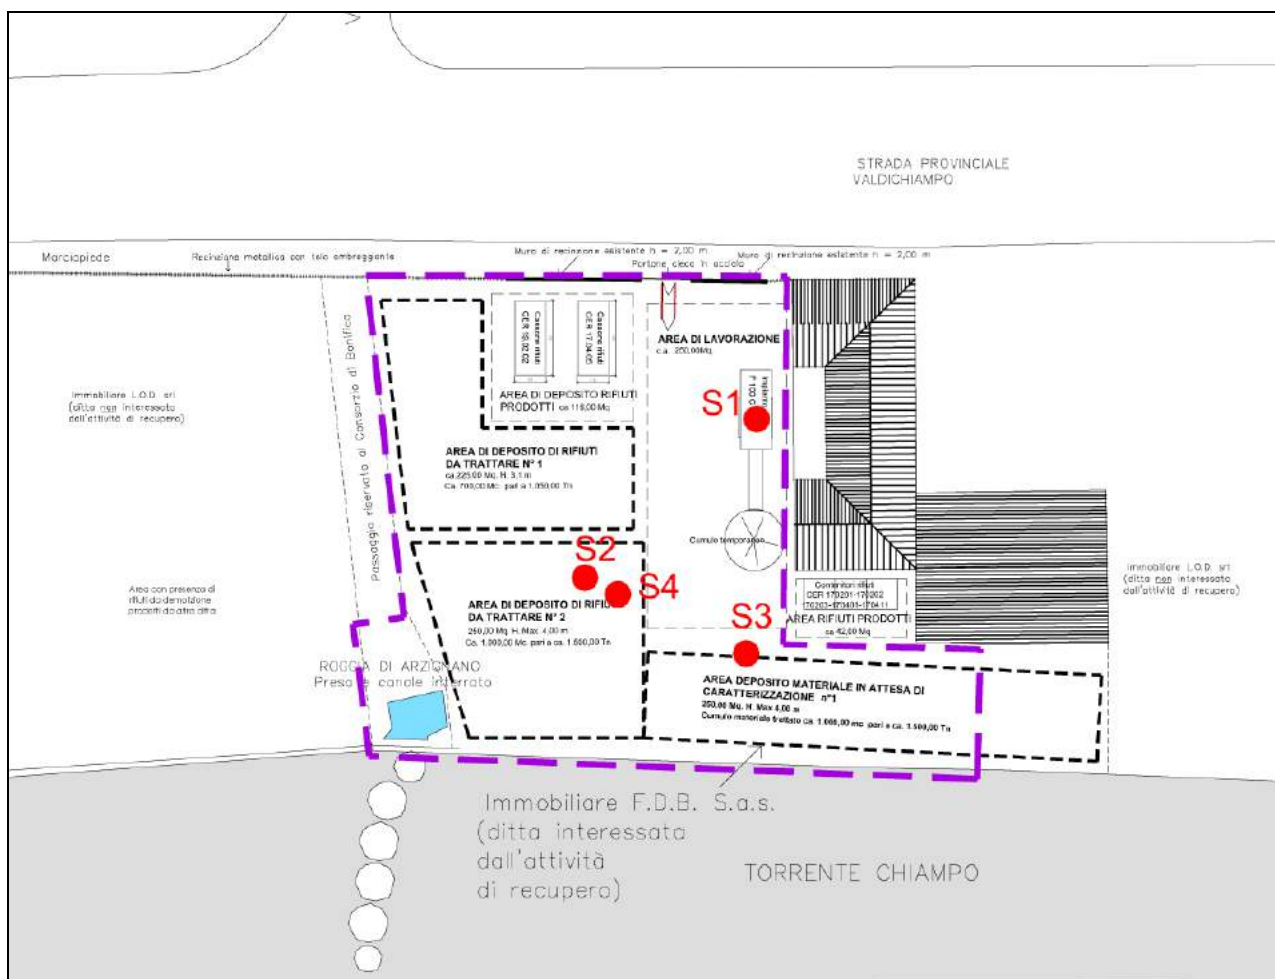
Planimetria di cantiere allegata al progetto con indicazione dell'ubicazione di massima delle sorgenti considerate
